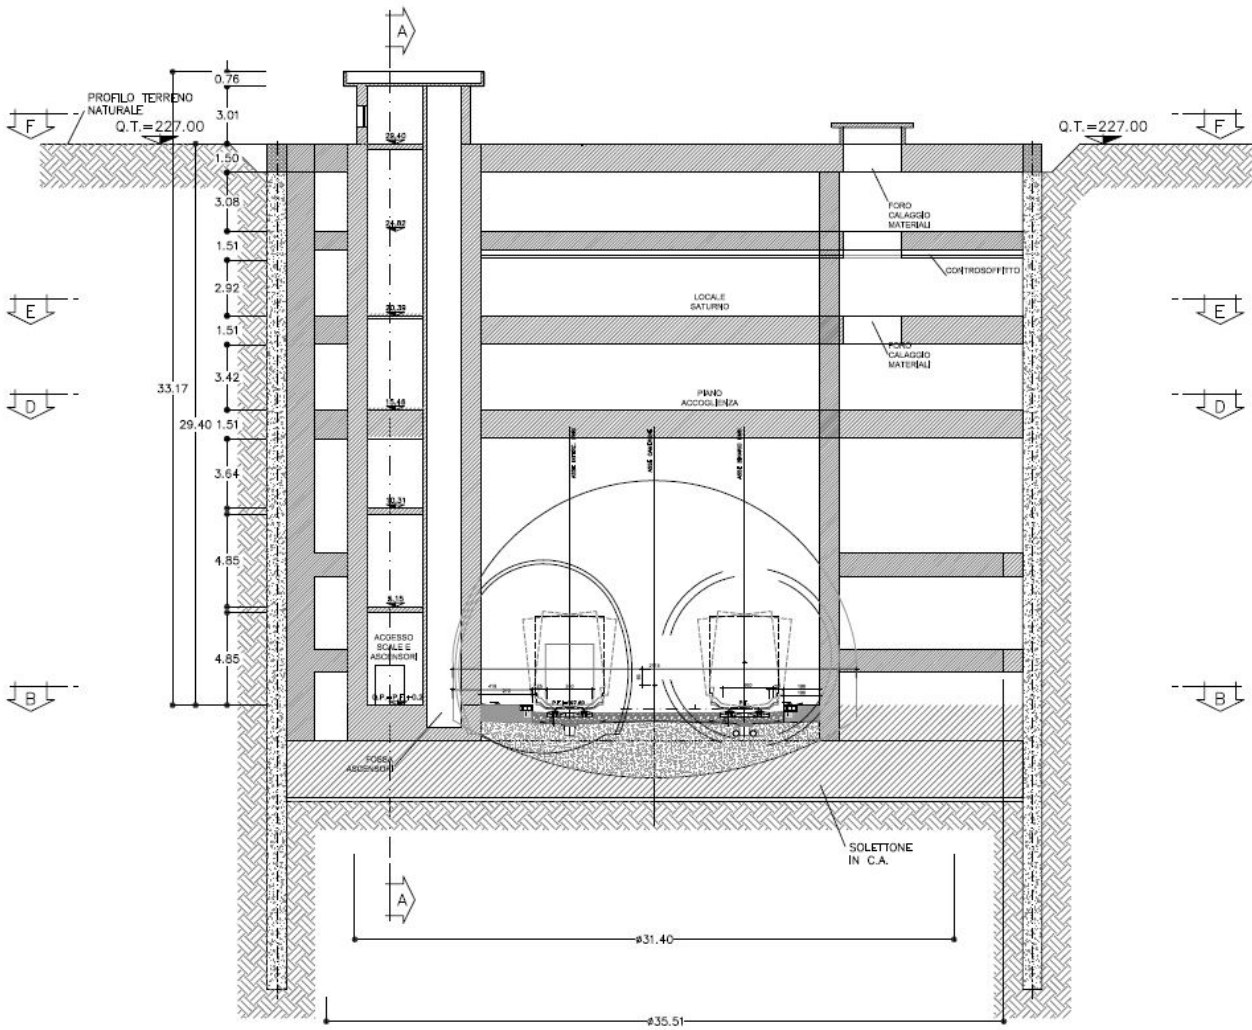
BP – Sezione uscita di sicurezza pozzo binario pari - Sezione trasversale
